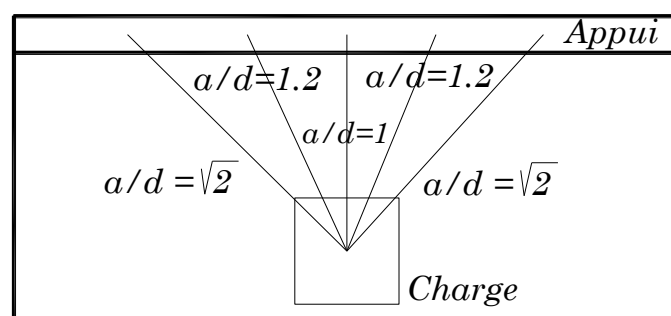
Eventail de bielles de compression dans une dalle par rapport à une poutre sous charge localisée : ratios a/d plus élevées dans les dalles par rapport aux poutres.
